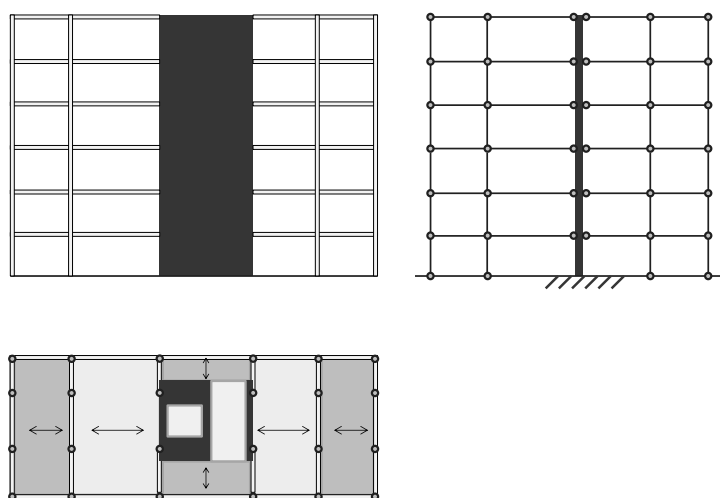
Vista (in alto) e pianta (in basso) della struttura portante principale in CA e della struttura secondaria formata da pilastri travi e solai in legno
